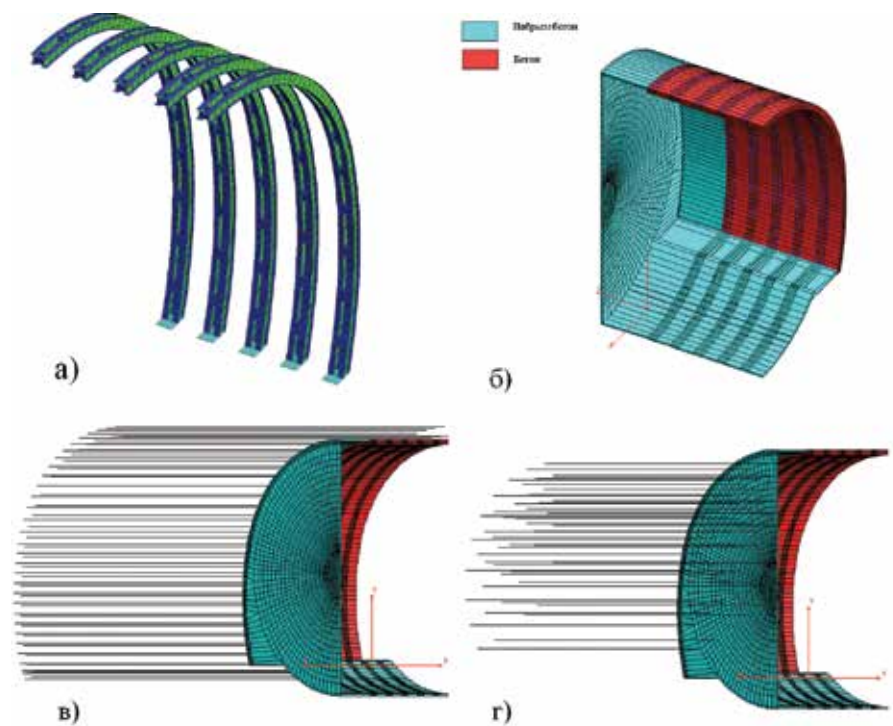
Фрагменты расчетной схемы: а) арки; б) набрызгбетон; в) экран из труб по контуру выработки; г) стекловолоконные трубы в забое
